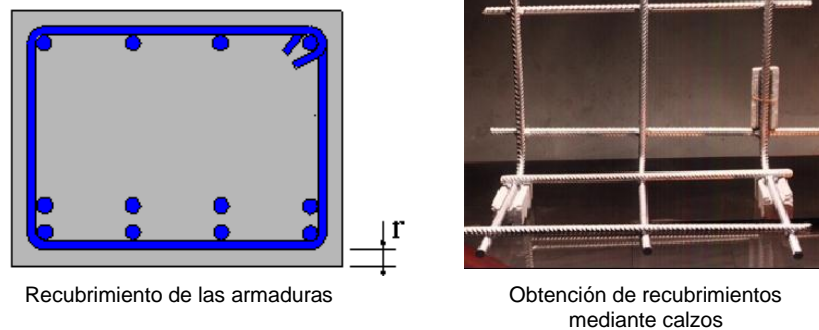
Uso de separadores para garantizar el recubrimiento de las armaduras
